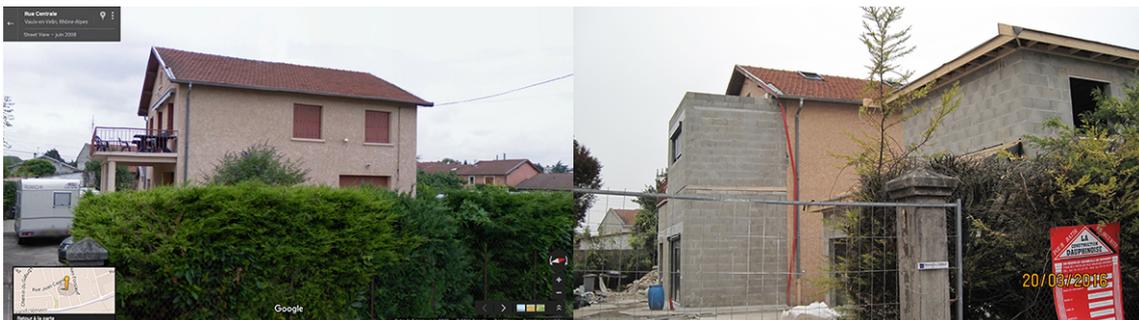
Agrandissement par extension horizontale (EH) en arrière plan et par division parcellaire et nouvelle construction (NC) au premier plan
